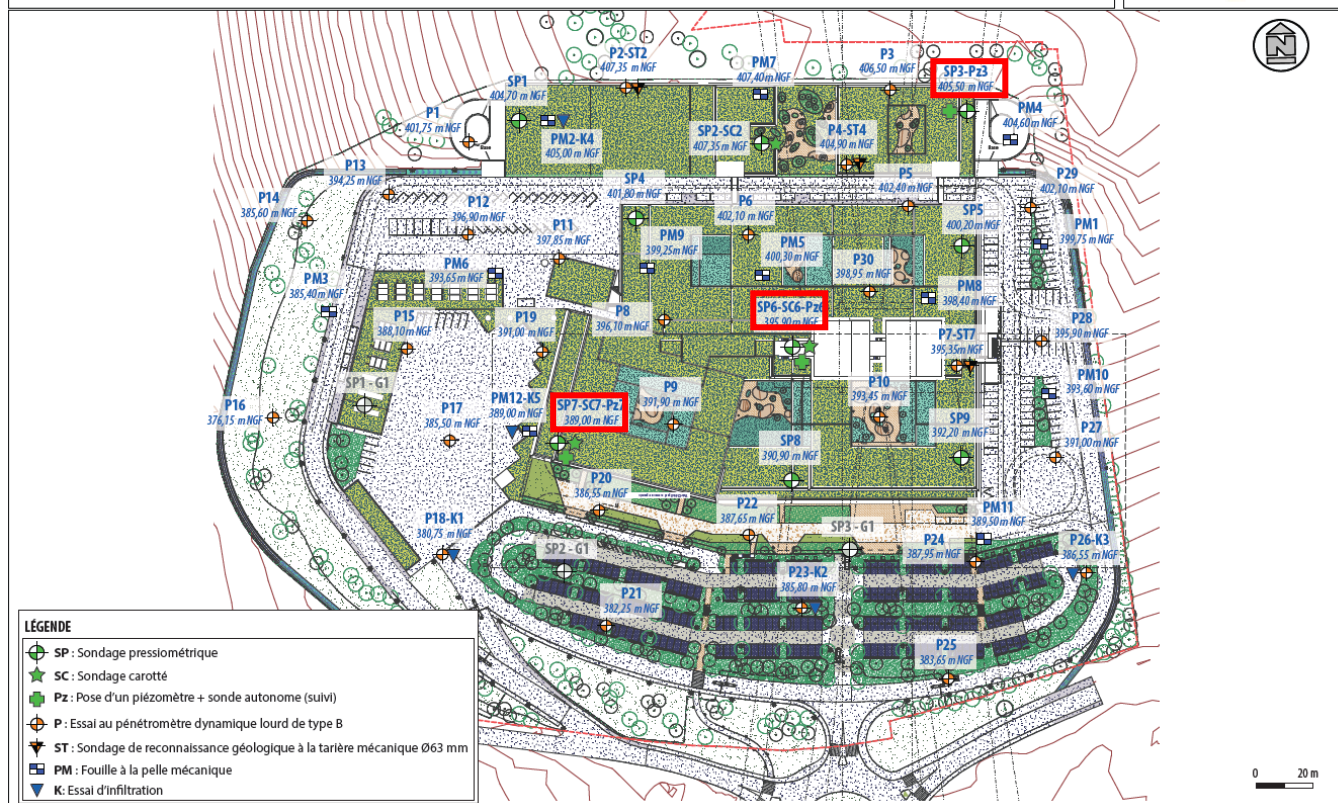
Localisation des piézomètres transposé sur le plan et coupe du projet
